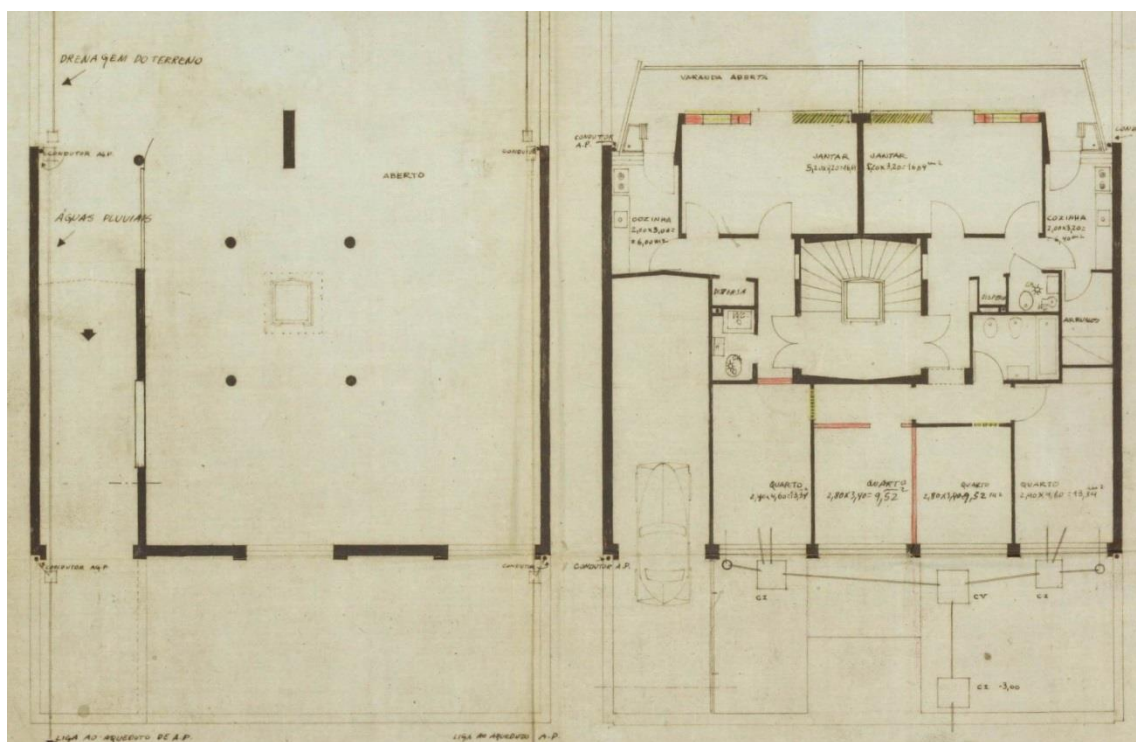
Planta do 1º piso, a cave com a garagem e planta do 2º piso.
